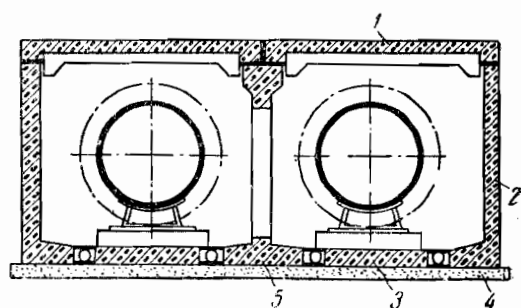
Теплопровод в сборном железобетонном непроходном канале.
